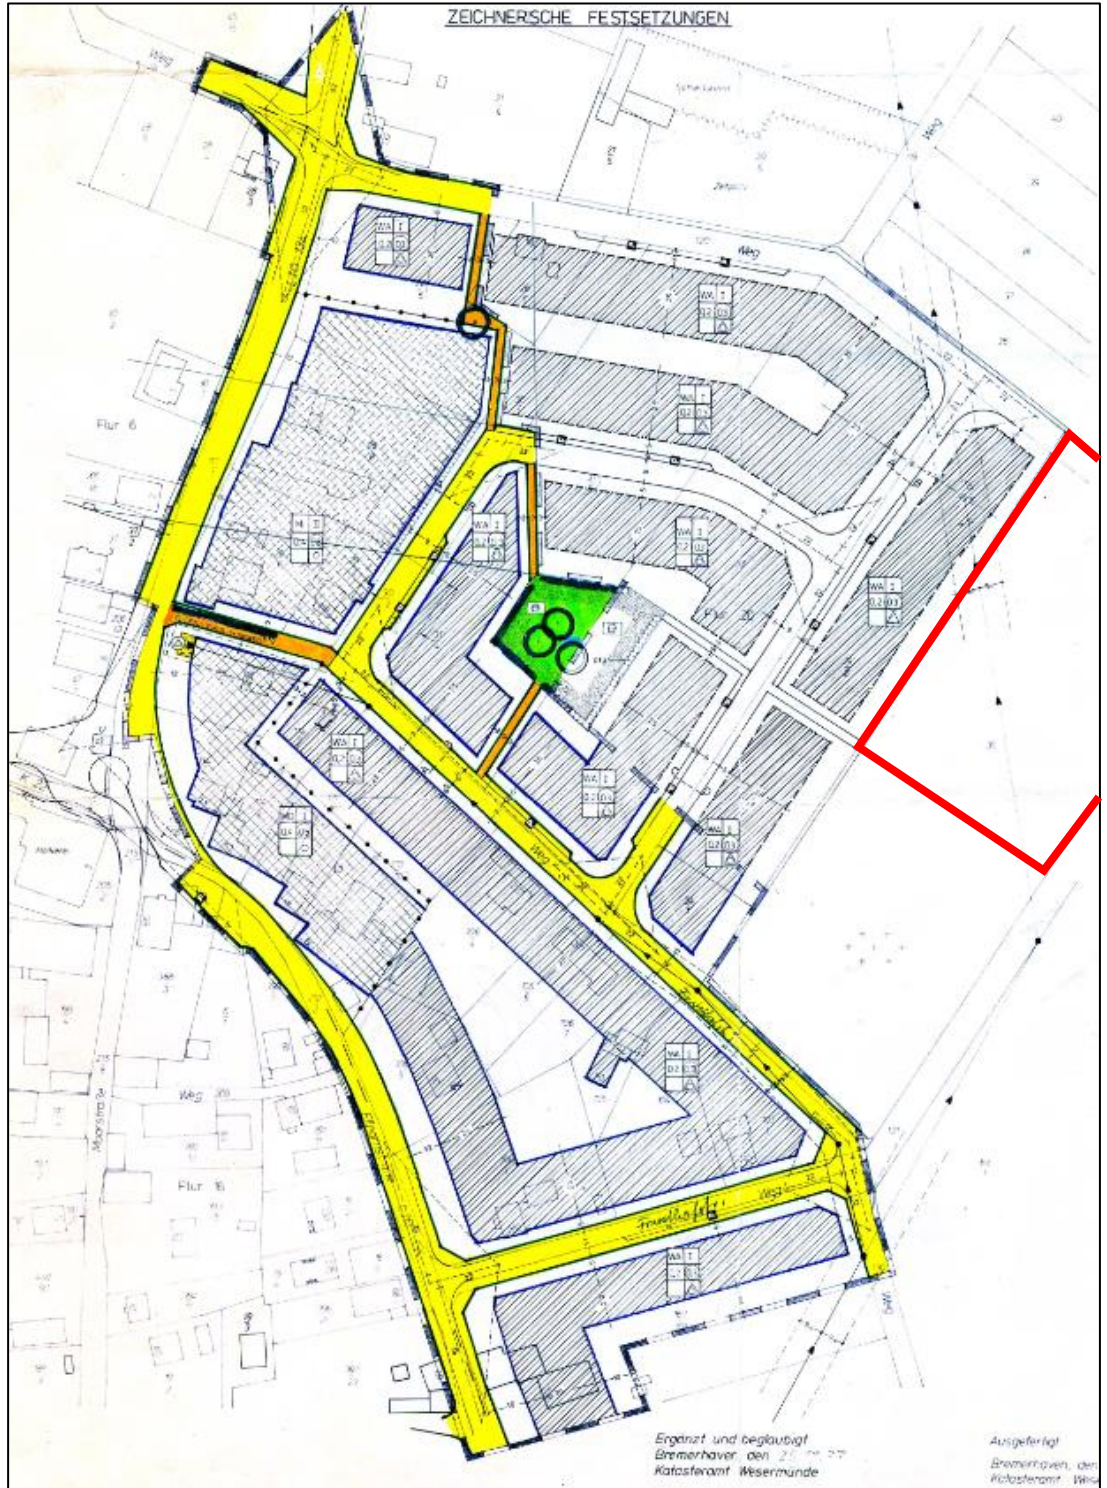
Bildausschnitt der Planzeichnung vom Bebauungsplan Nr. 1 „Landwehracker“ Gemeinde Uthlede; geplante Wohnbaufläche in rot dargestellt)
